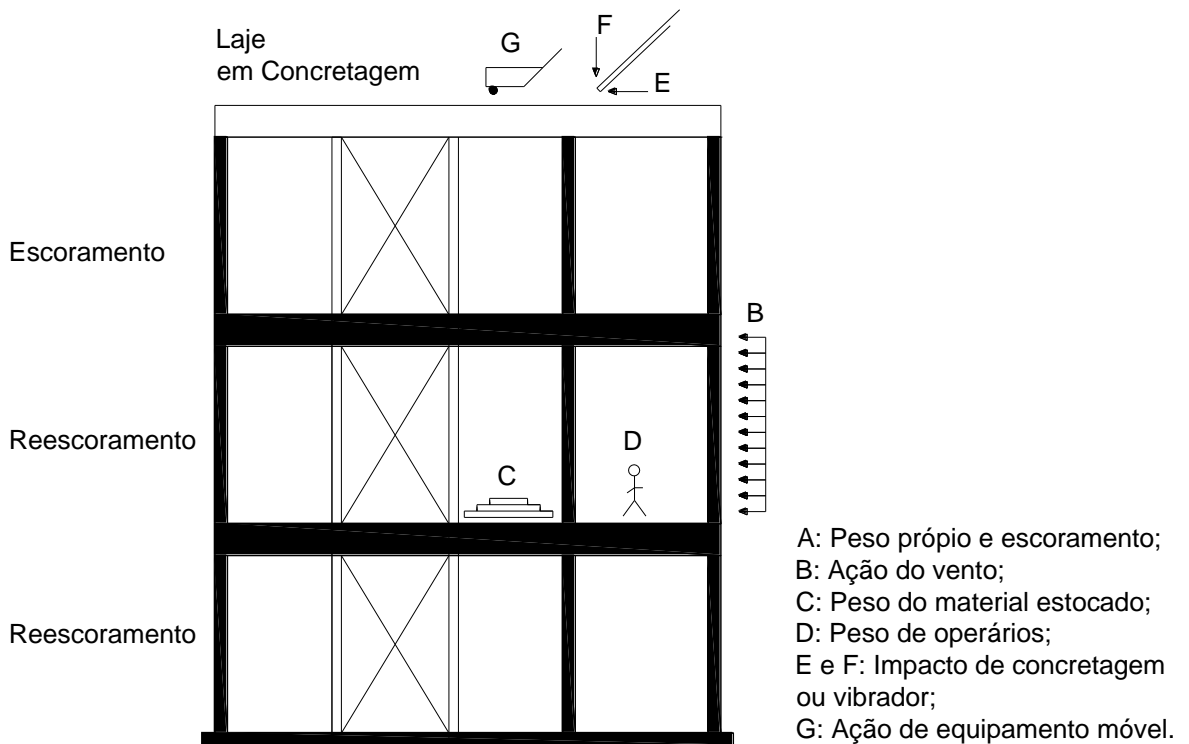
Sistema de escoramento e ações de construções, CUNHA (1998)
